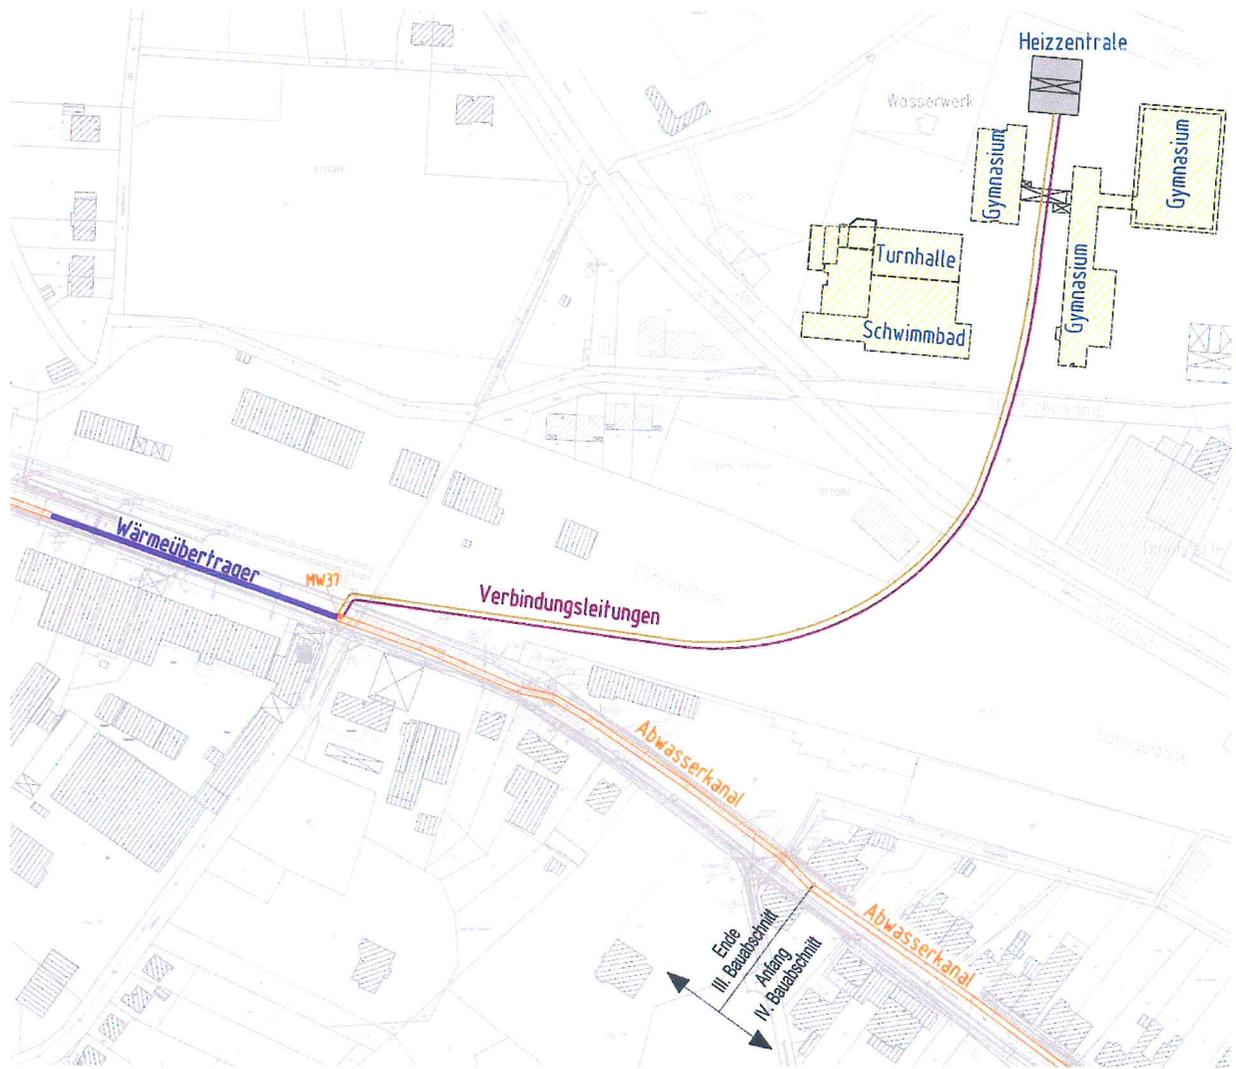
Lageplan Abwasserwärmeübertrager im 3. Bauabschnitt und Trasse Verbindungsleitung
